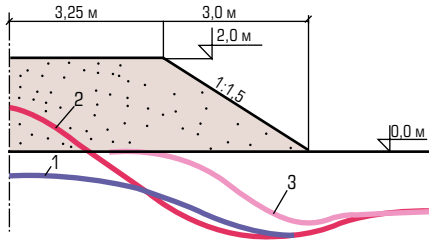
Положение границы оттаивания грунтов в основании низких насыпей: 1 — без устройства теплоизоляции; 2 — при укладке теплоизоляции на основной площадке; 3 — при укладке теплоизоляции на откосах
